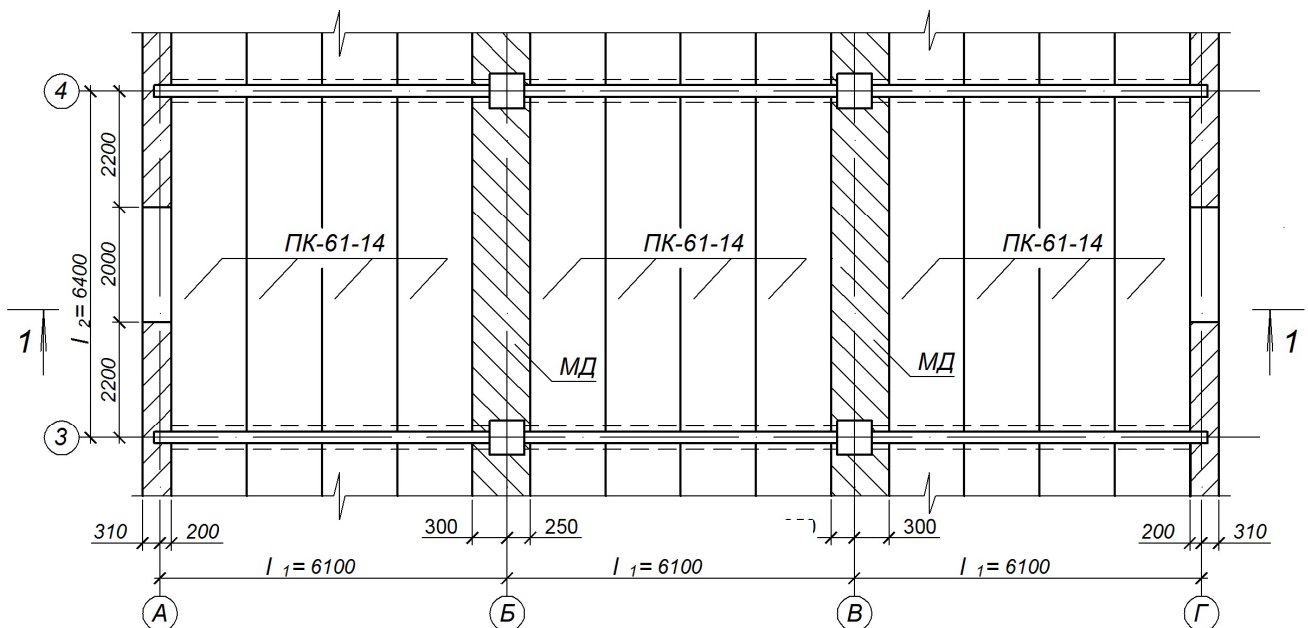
Приклад компонування збірного перекриття цивільної будівлі (фрагмент).
